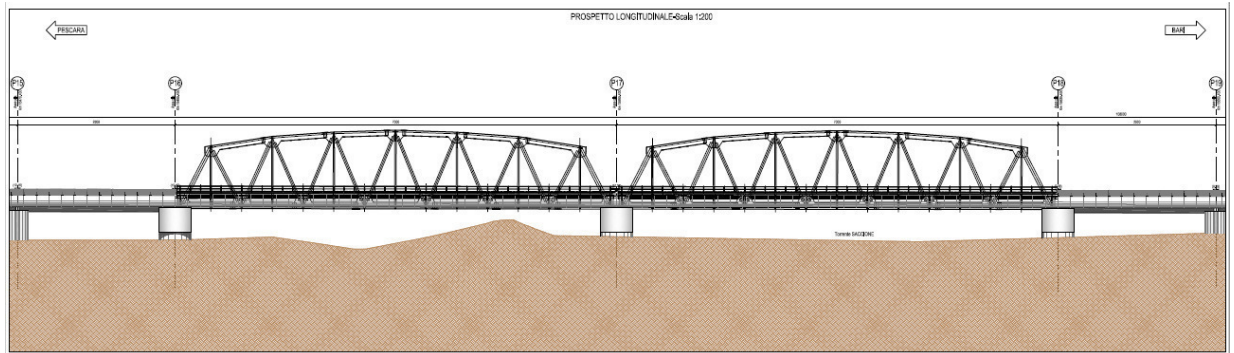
Attraversamento del Torrente Saccione – Impalcati con travate metalliche reticolari a via inferiore di luce L=70 m
